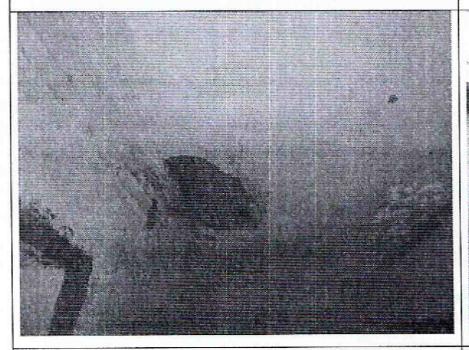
Desprendimiento del cielo raso bajo cubierta.
